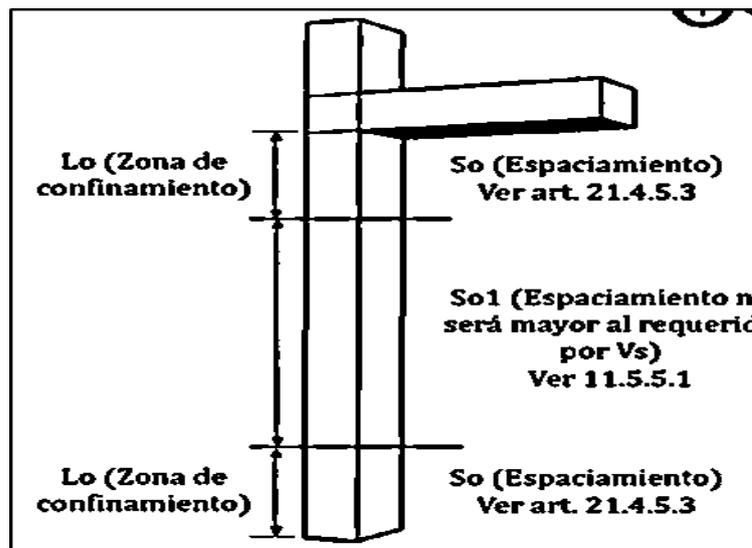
LONGITUD DE ZONA DE CONFINAMIENTO
